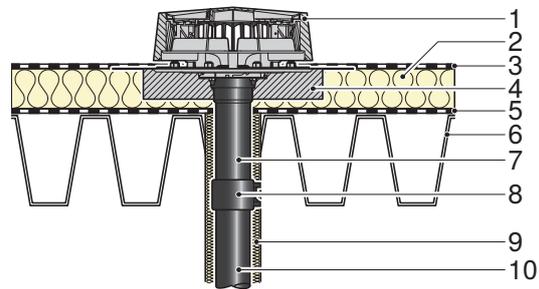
Монтаж на изолированной легкой кровле с кровельным покрытием
